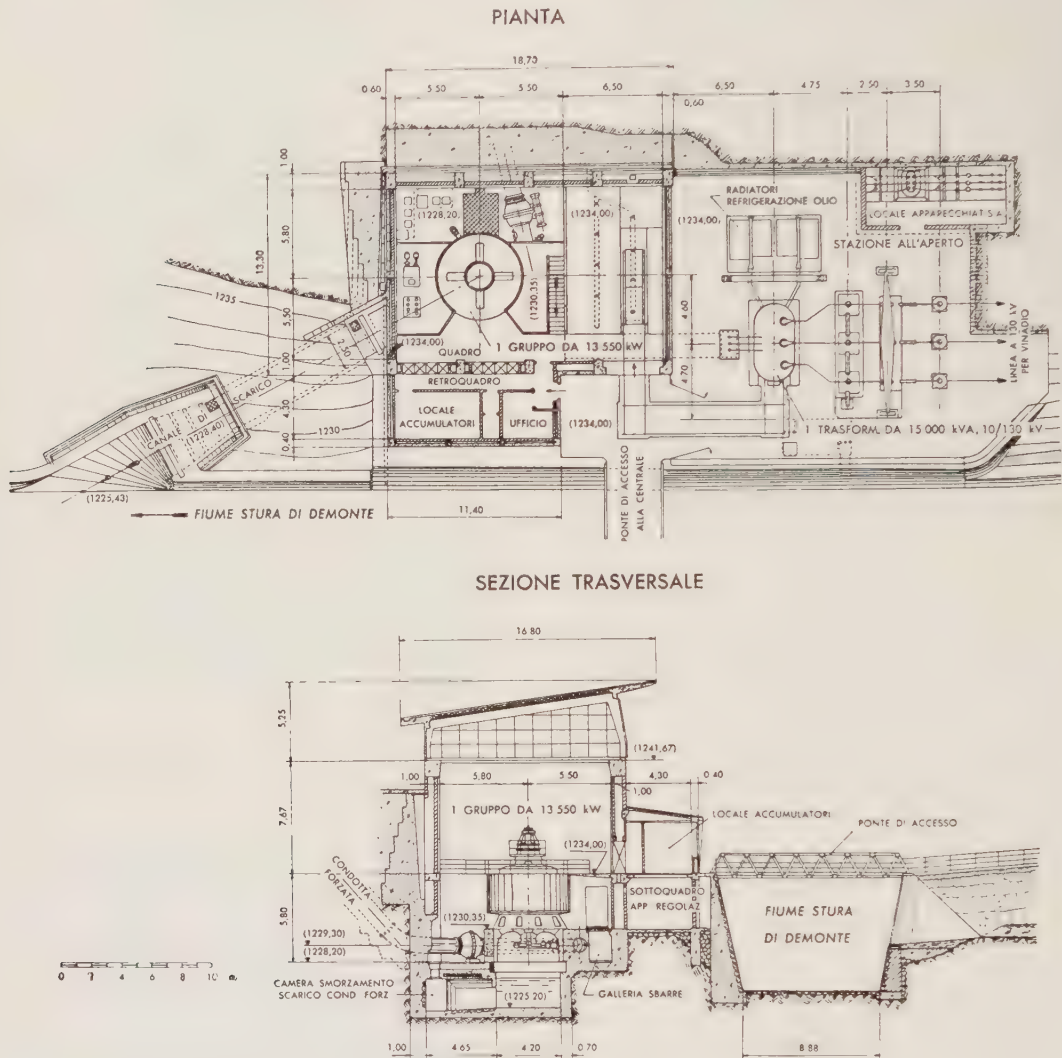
Pianta e sezione della centrale dell'impianto 1° salto.
